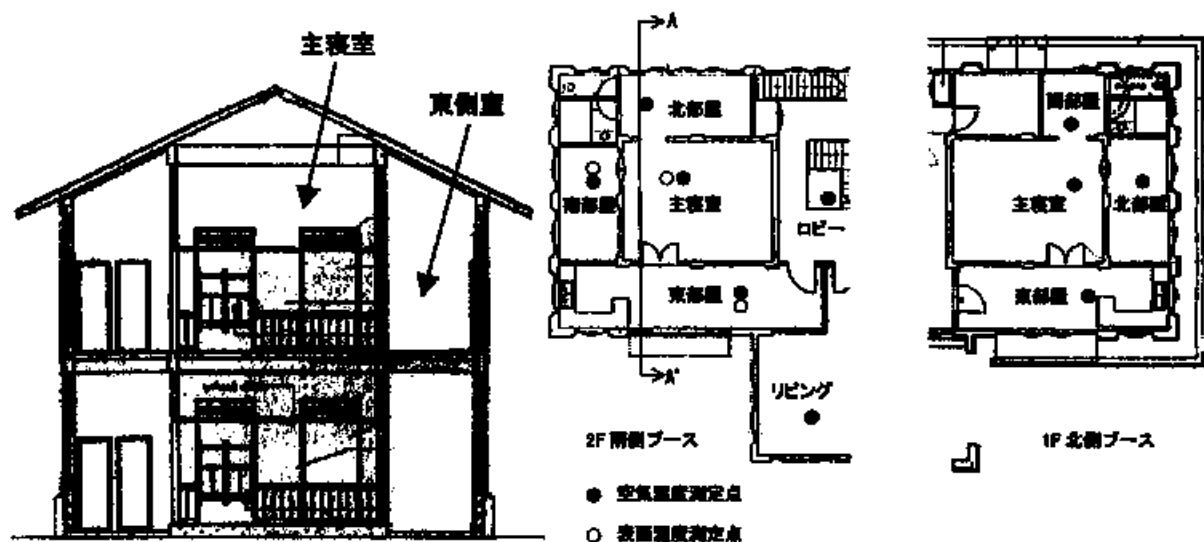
建物 A-A' 断面図と平面図 (左:断面図、右:平面詳細図)
